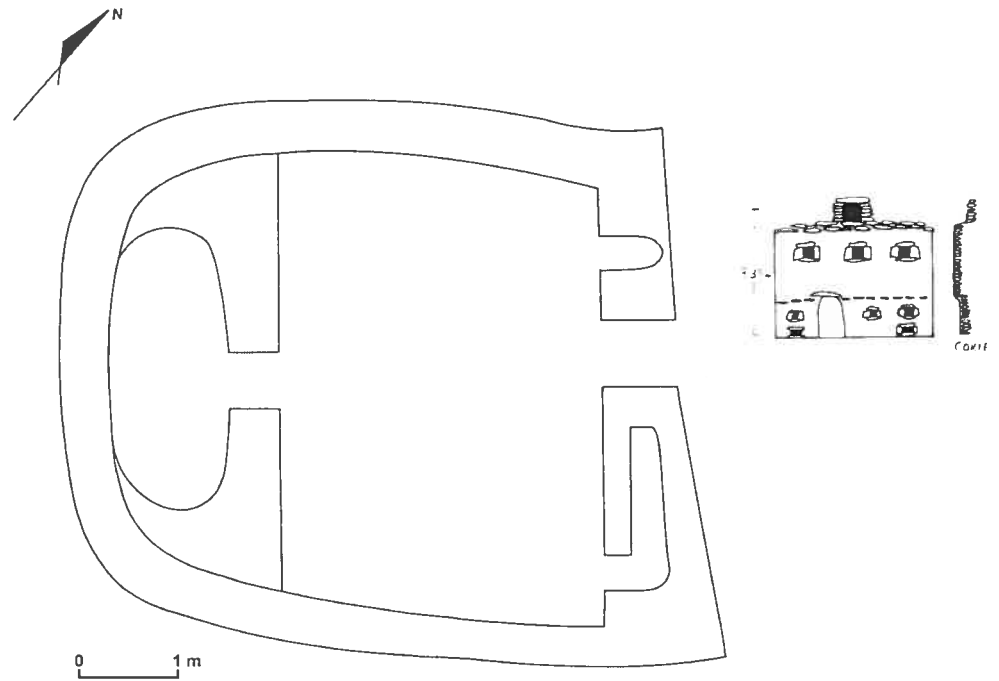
Plan de l'habitation A, et croquis de face et de profil de la façade principale interne du site # 56 (Parina V) de Huacchis.
